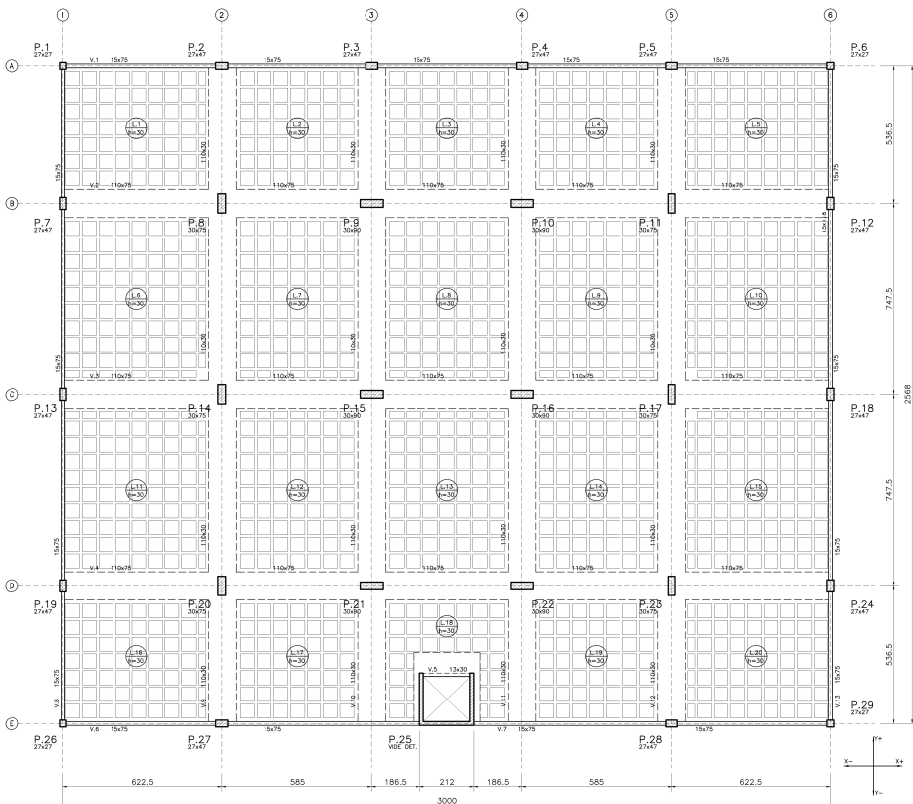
Forma do pavimento tipo da Estrutura 2C.
